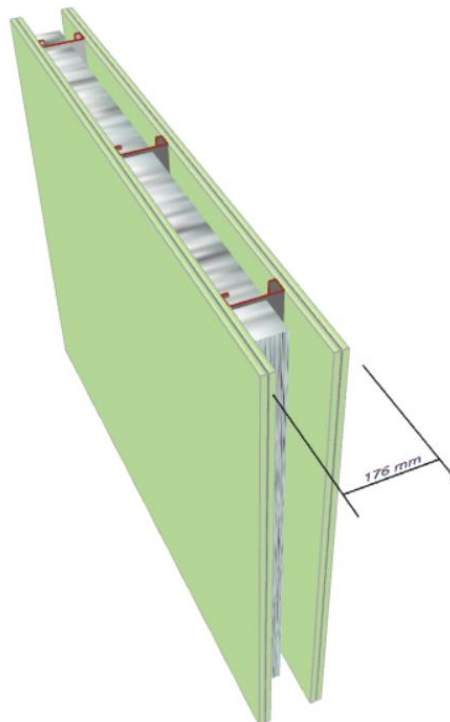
Montante Acero Galvanizado (1,0-1,6mm) INSUL
